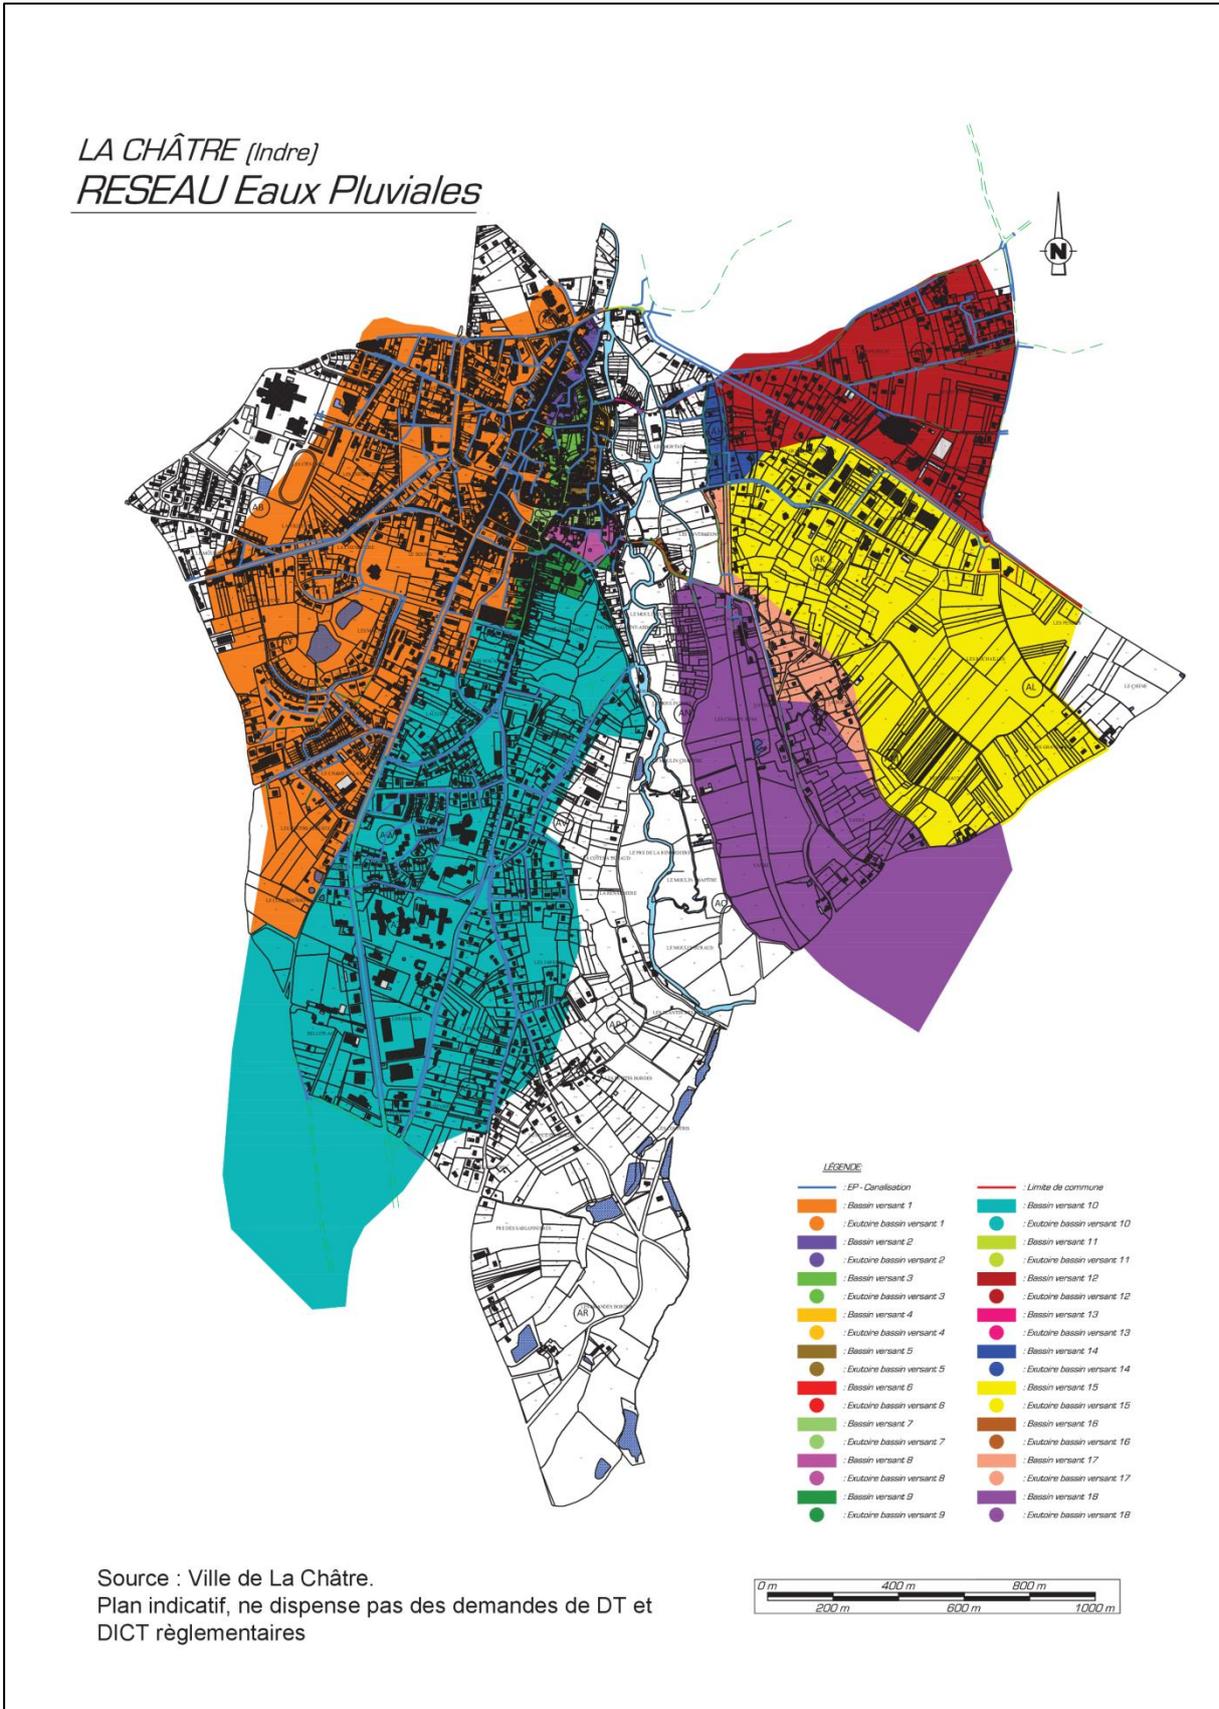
Plan du réseau eaux pluviales de la commune de La Châtre
